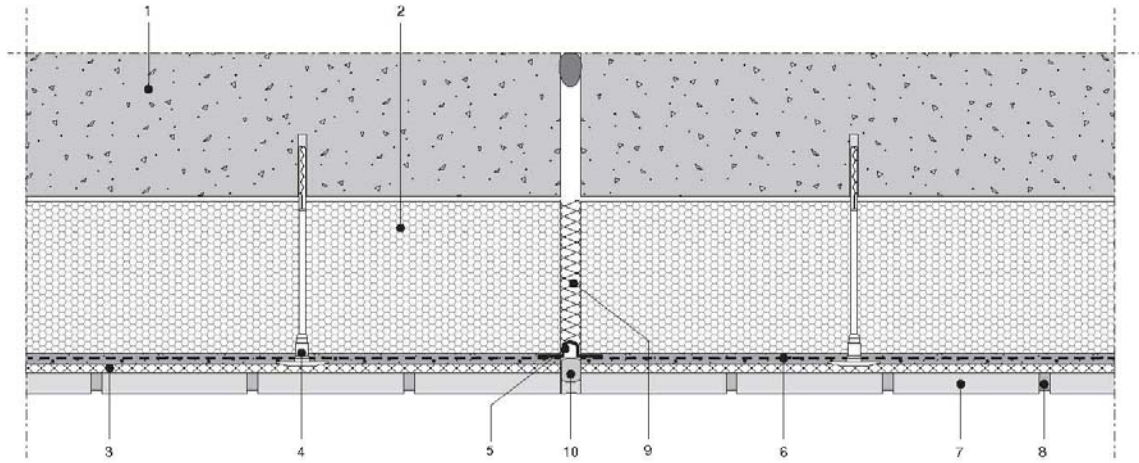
Raccordement avec utilisation d'un profilé d'arrêt en PVC entoilé
